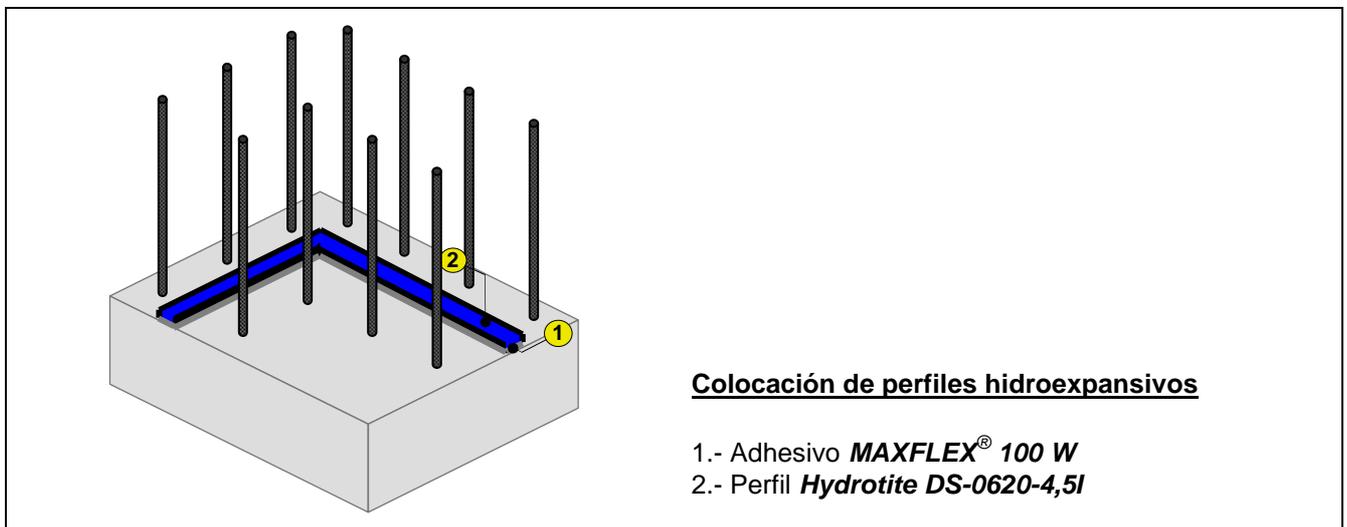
Colocación de perfil hidroexpansivo en juntas entre losa y muro o en juntas de hormigonado de losa o muros
